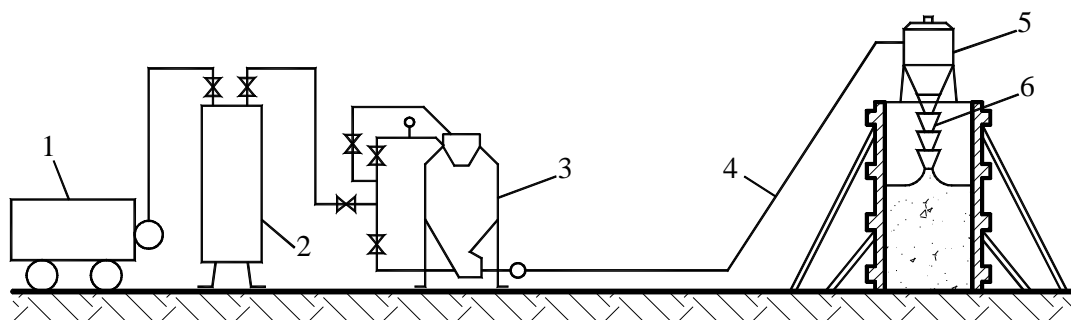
Схема бетонування за допомогою пневмонагнітання:
